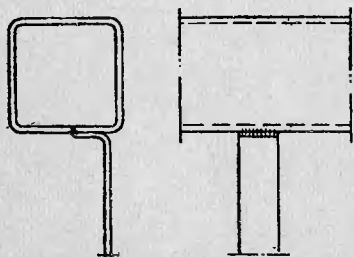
Ответвление сваркой плоской шины от профильной.
